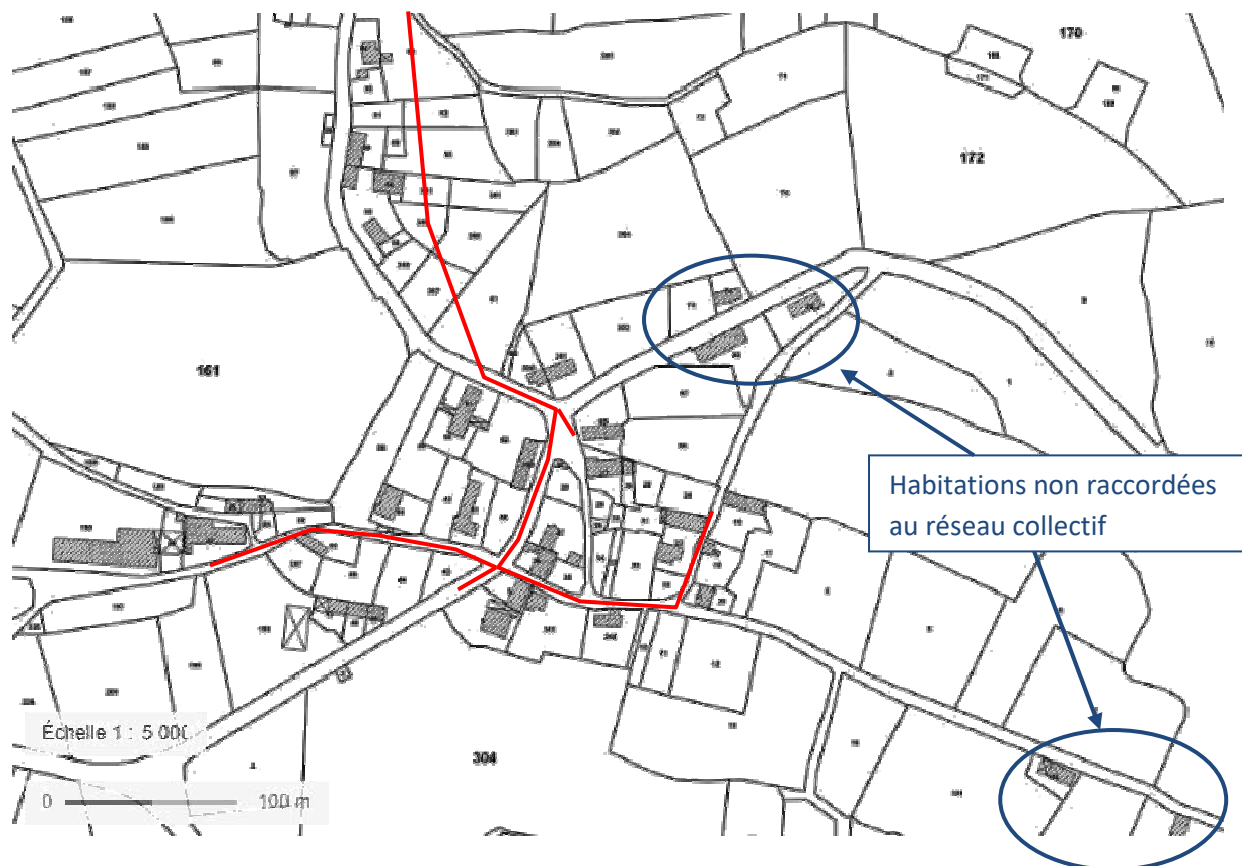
Plan du réseau d'assainissement collectif du hameau de L'Huis Prunelle (source Commune de Planchez)
